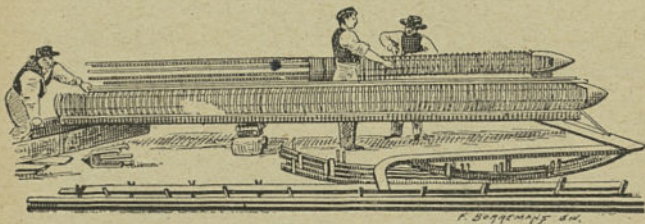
Fabrication de pilots en ciment armé ; montage de l'armature.
